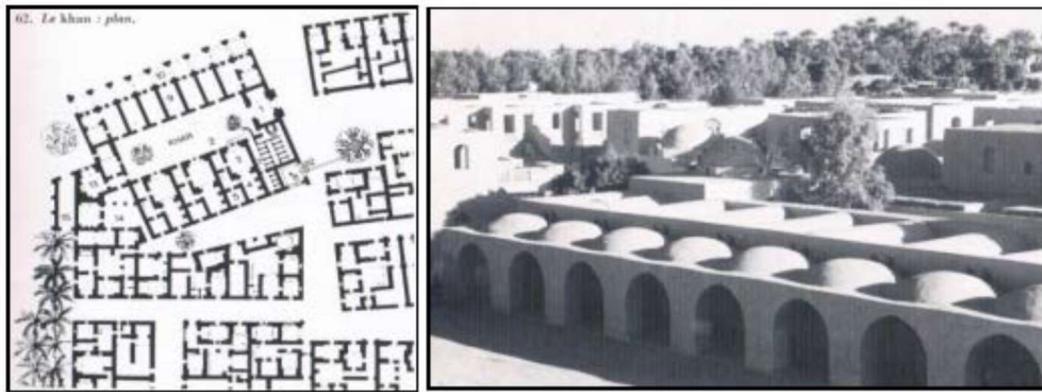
Le khan, plan, façade nord. Source : FATHY Hassan. Op.cit., planches 62-64.
